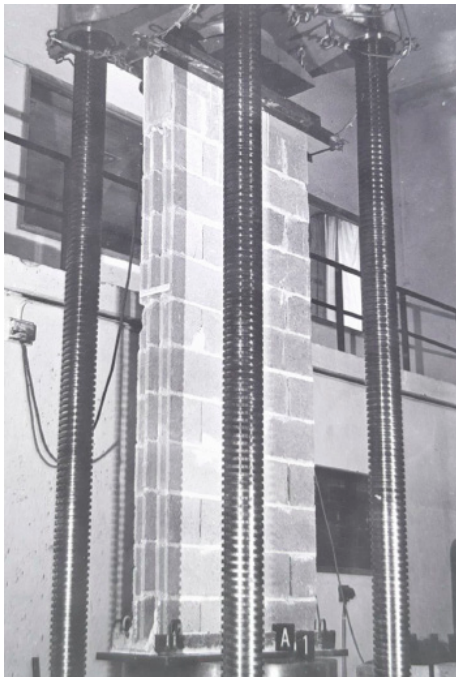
Detalle constructivo muro sistema Tabibloc
